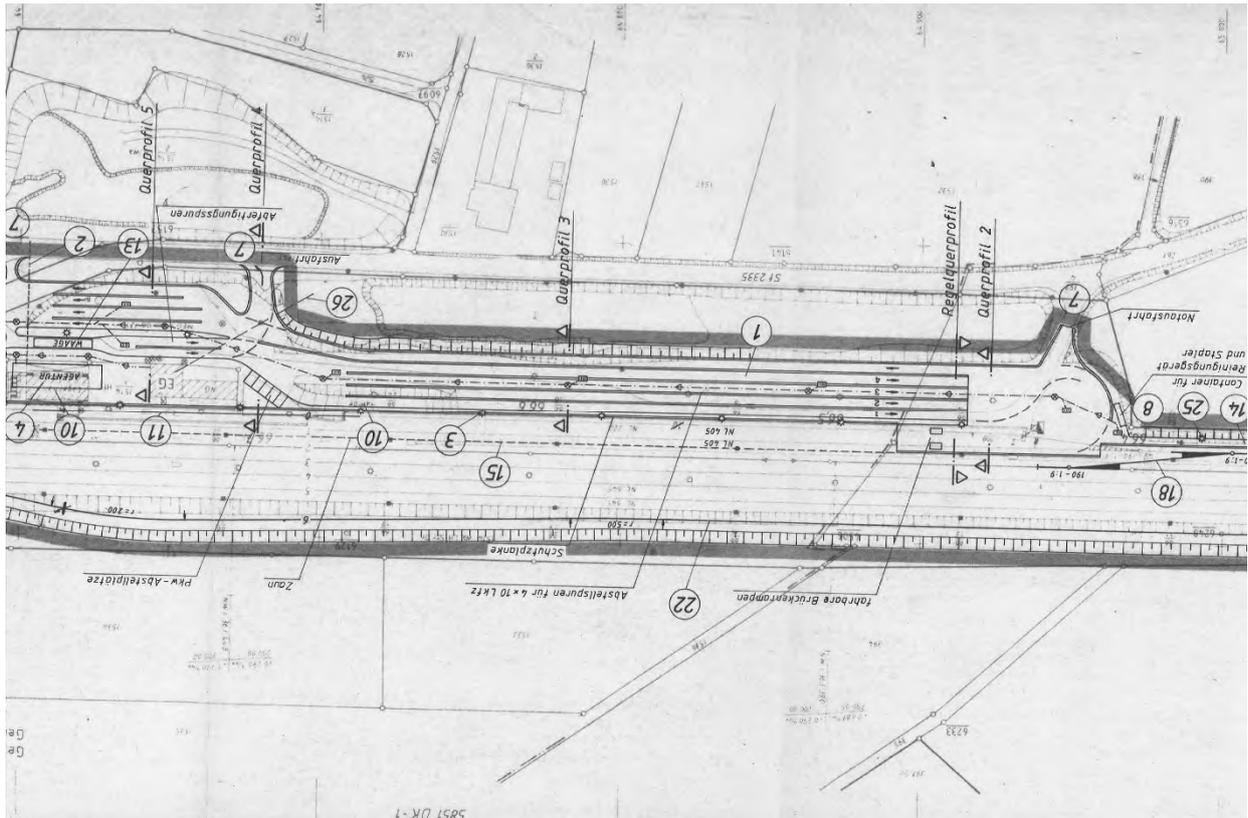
Planfeststellungsentwurf für das Plangebiet, Stand 06.04.1992
